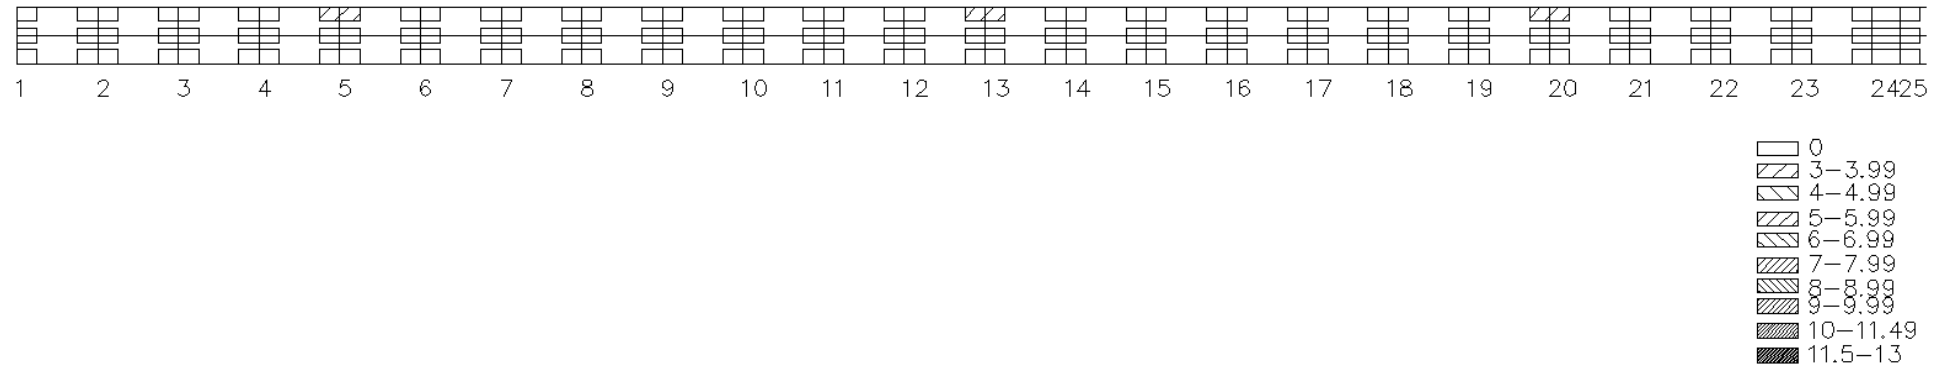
Ausgleichungsdicken bei kubischer Splinefunktion und Verfahrensplan Typ C, Grundriss, Stationen 1-25
